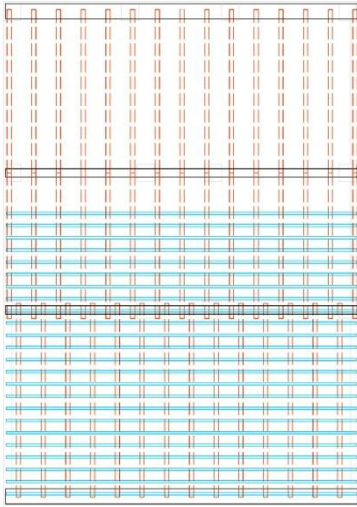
y 38. Plano distribución de los pares, vigas de madera y rastreles, y diagrama de los 3 tipos de tipologías existentes. 2016. Propia.
